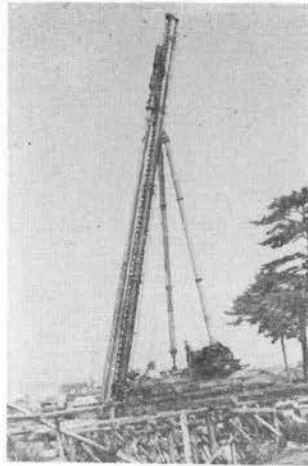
天竺川橋 H-くい施工状況, IDH-22 使用
